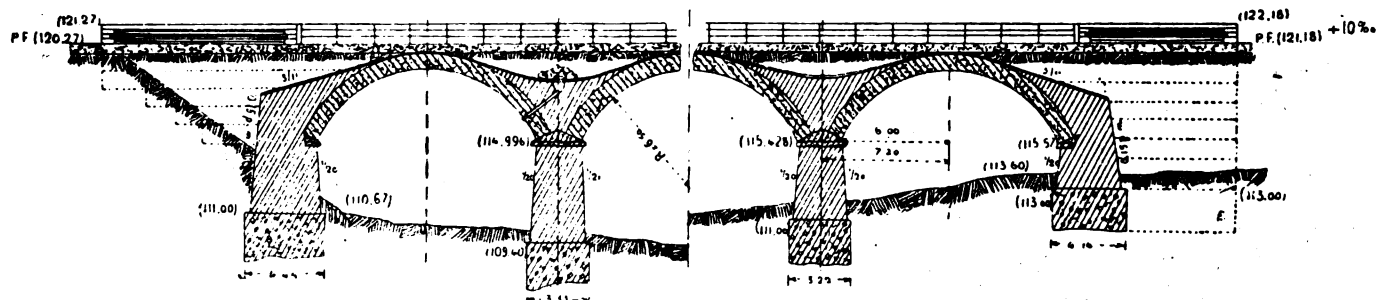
Ponte in muratura sul Fiume Calore. - Sezione longitudinale.
